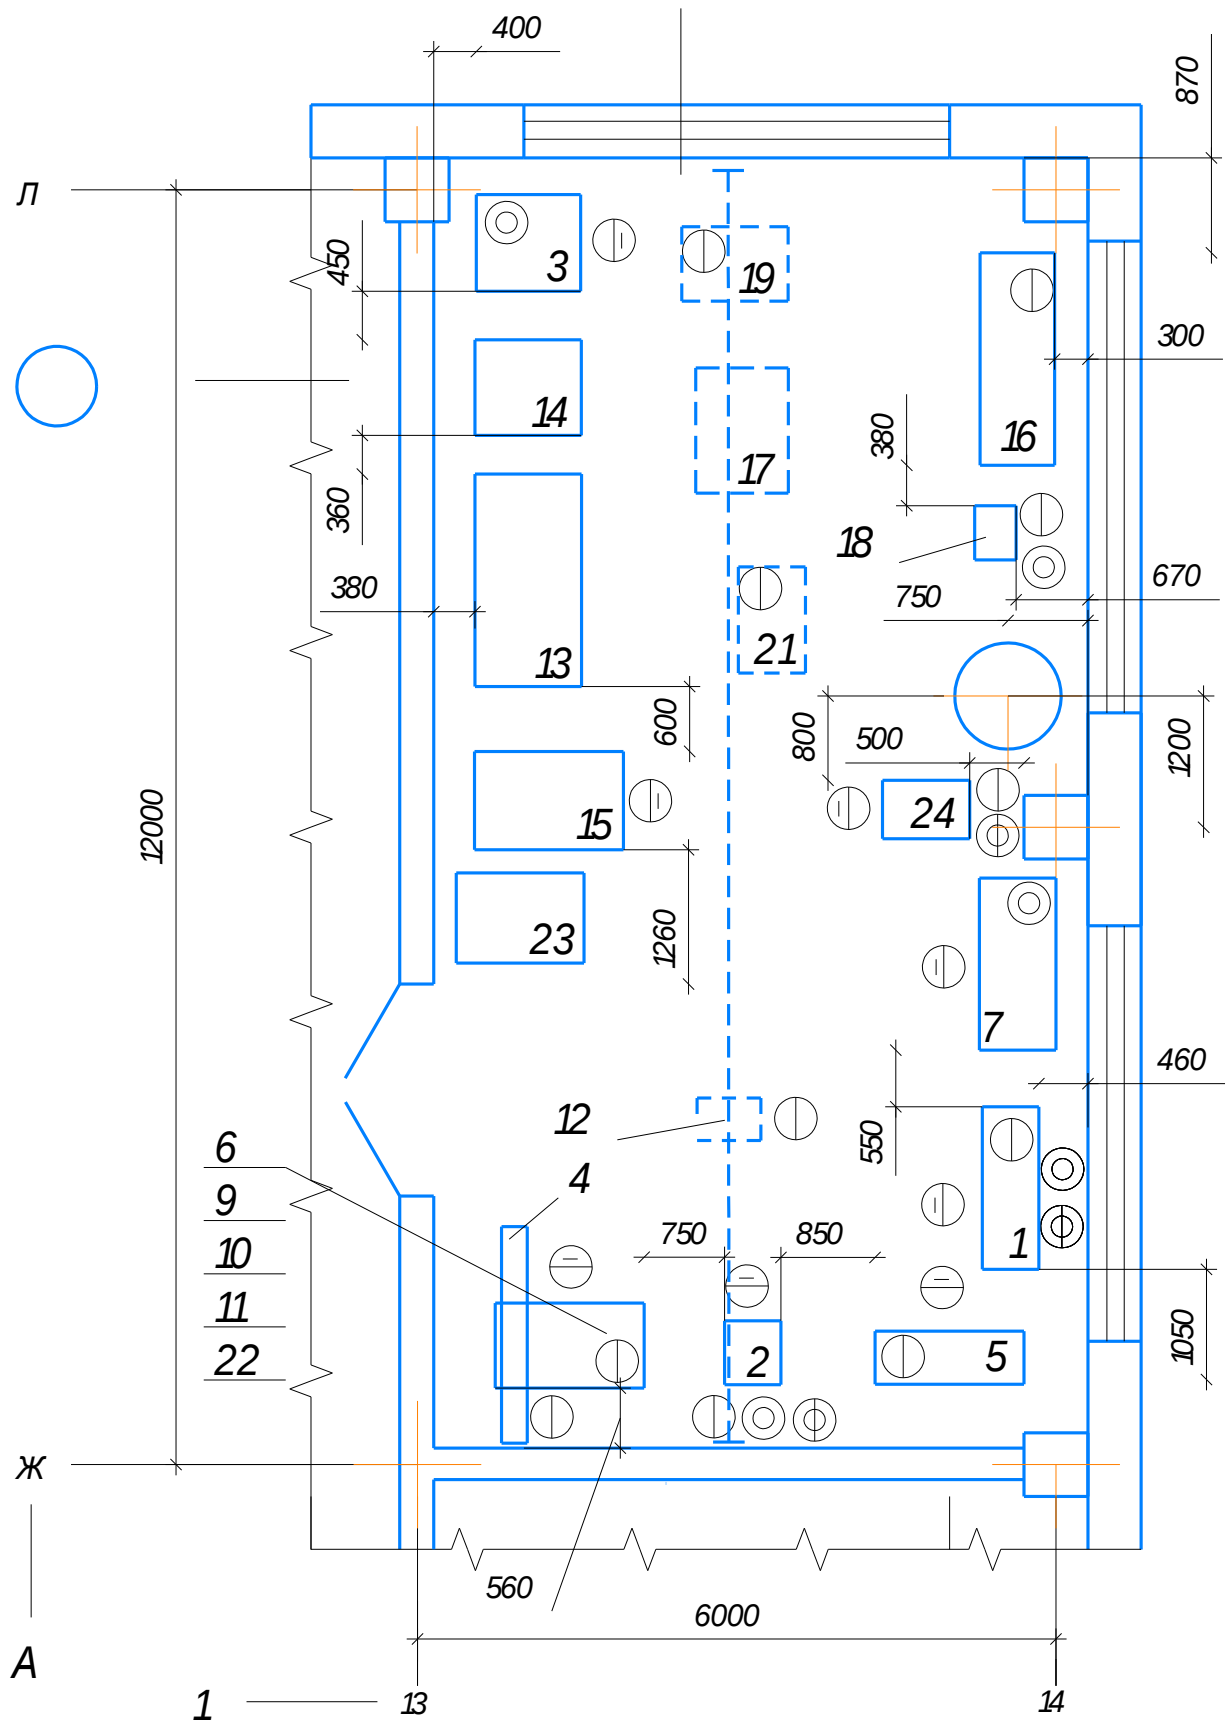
Планування шинної дільниці та розташування обладнання
